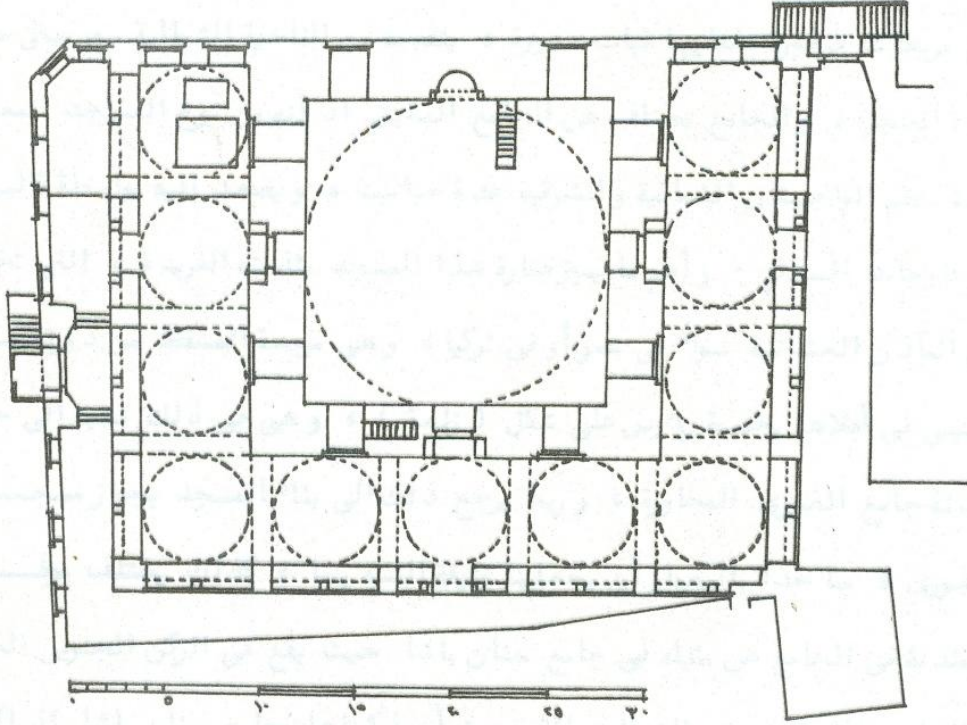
مسقط أفقي لمنشأة كافور الزمام. عن: محمد حمزة
